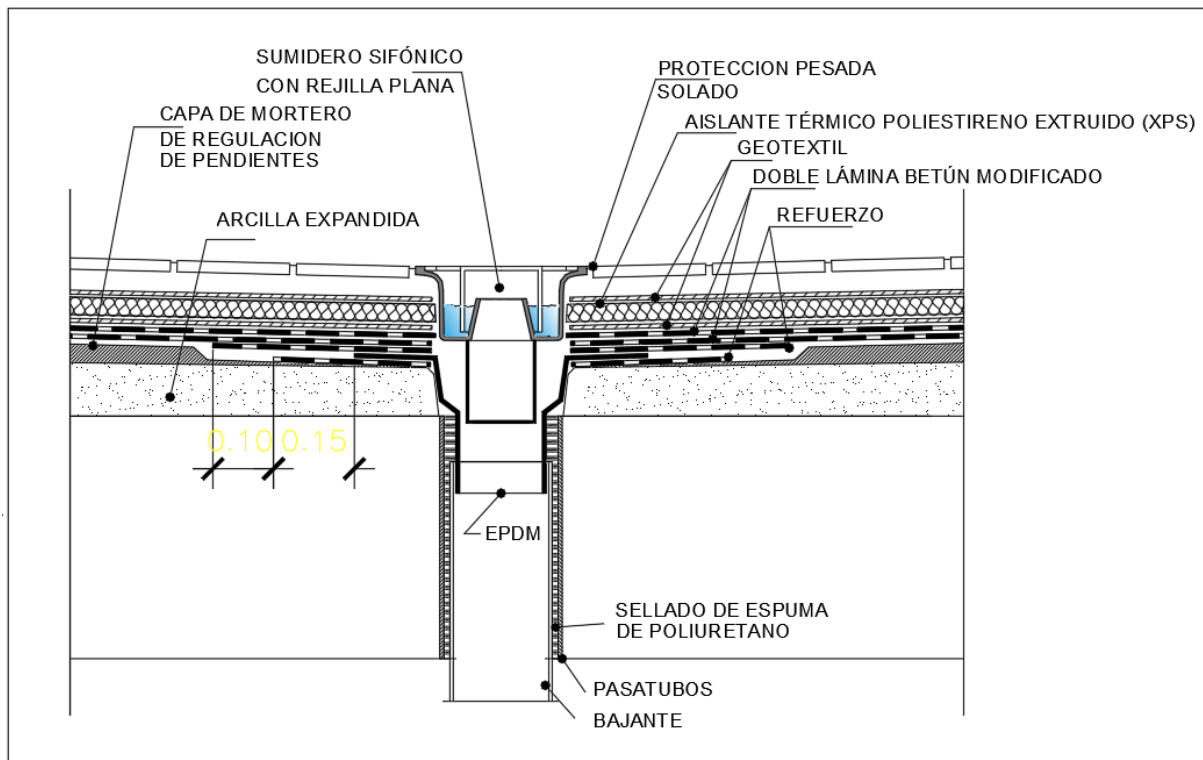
Detalle constructivo sumidero azotea plana transitable. 2019. Fuente propia.
